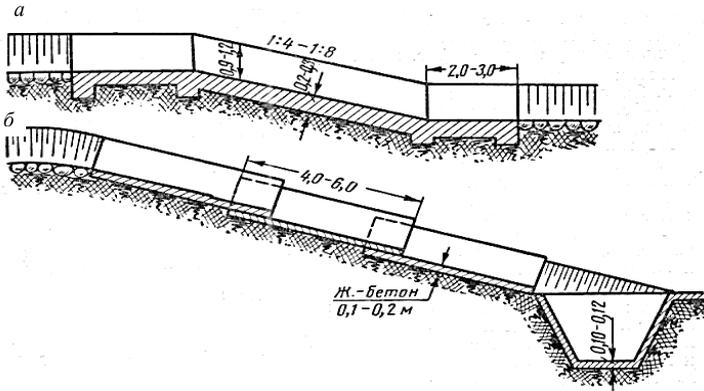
Быстроток: *а* – бетонный, *б* – железобетонный
